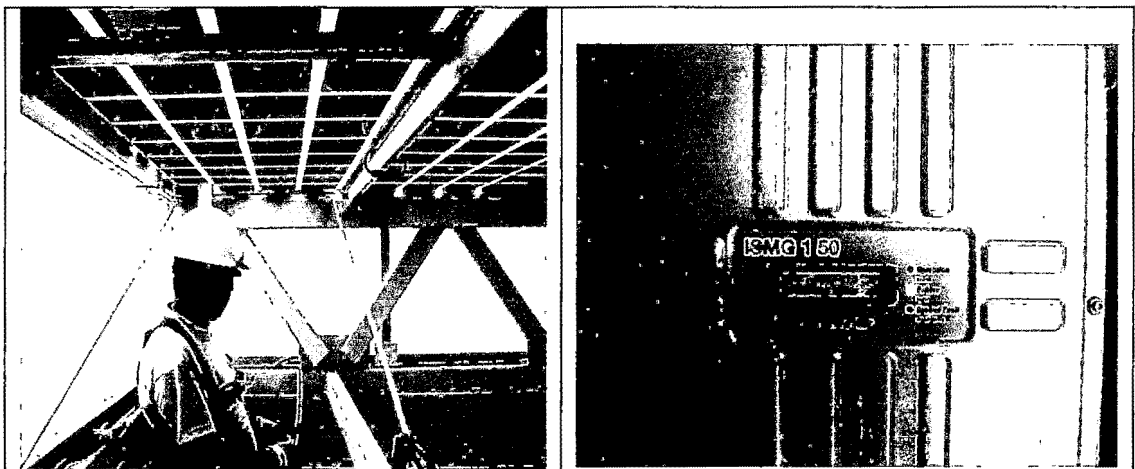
Vista lado inferior del lado de las conexiones eléctricas
